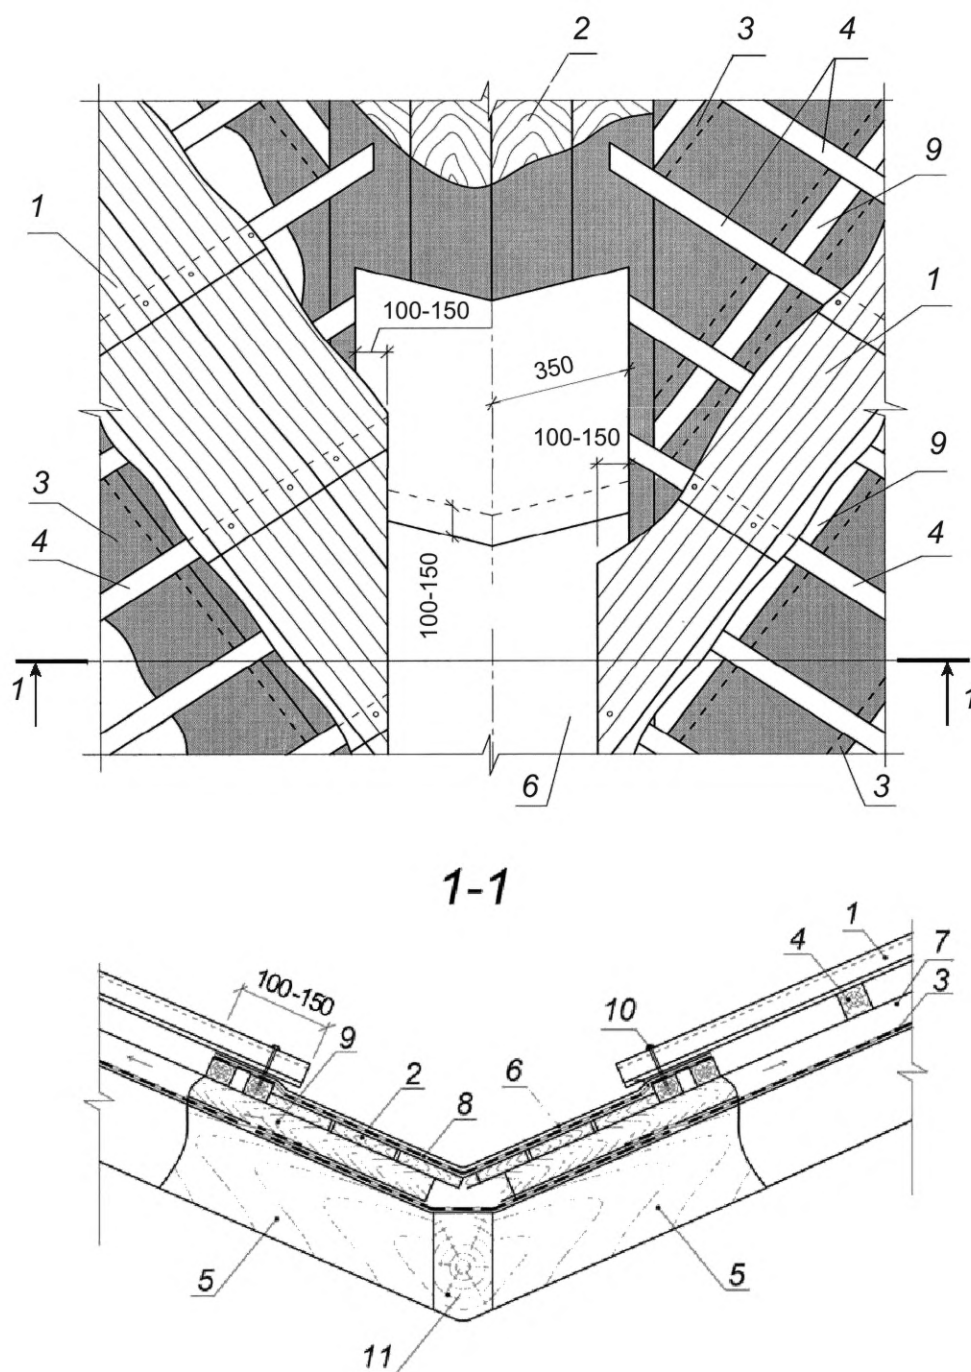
Укладка хризотилцементных плиток прямоугольной формы
